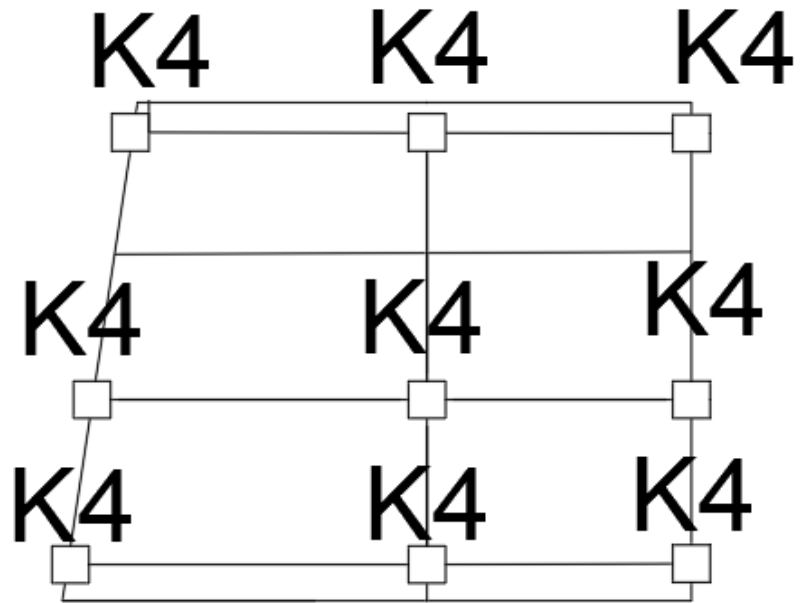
Denah *Final* Kolom Bangunan B.1
